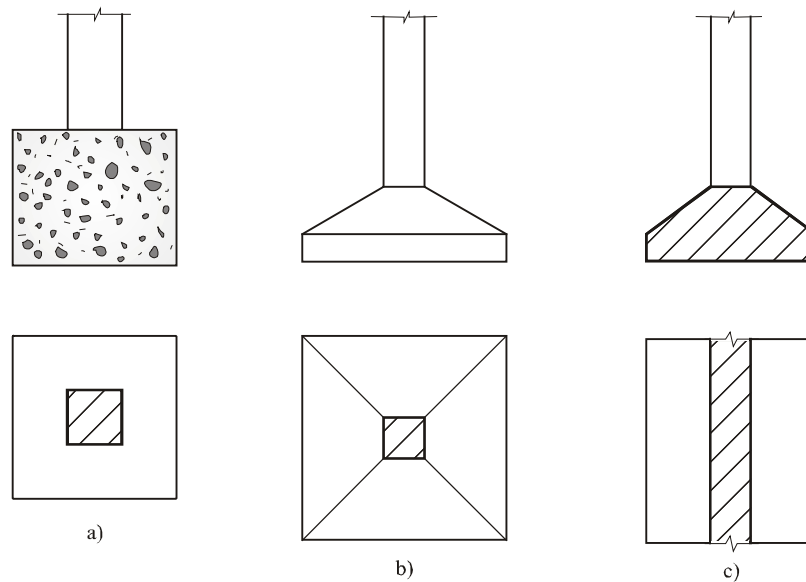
Fundações diretas: a) bloco isolado de concreto ciclópico ou alvenaria de pedra; b) sapata isolada; c) sapata corrida
